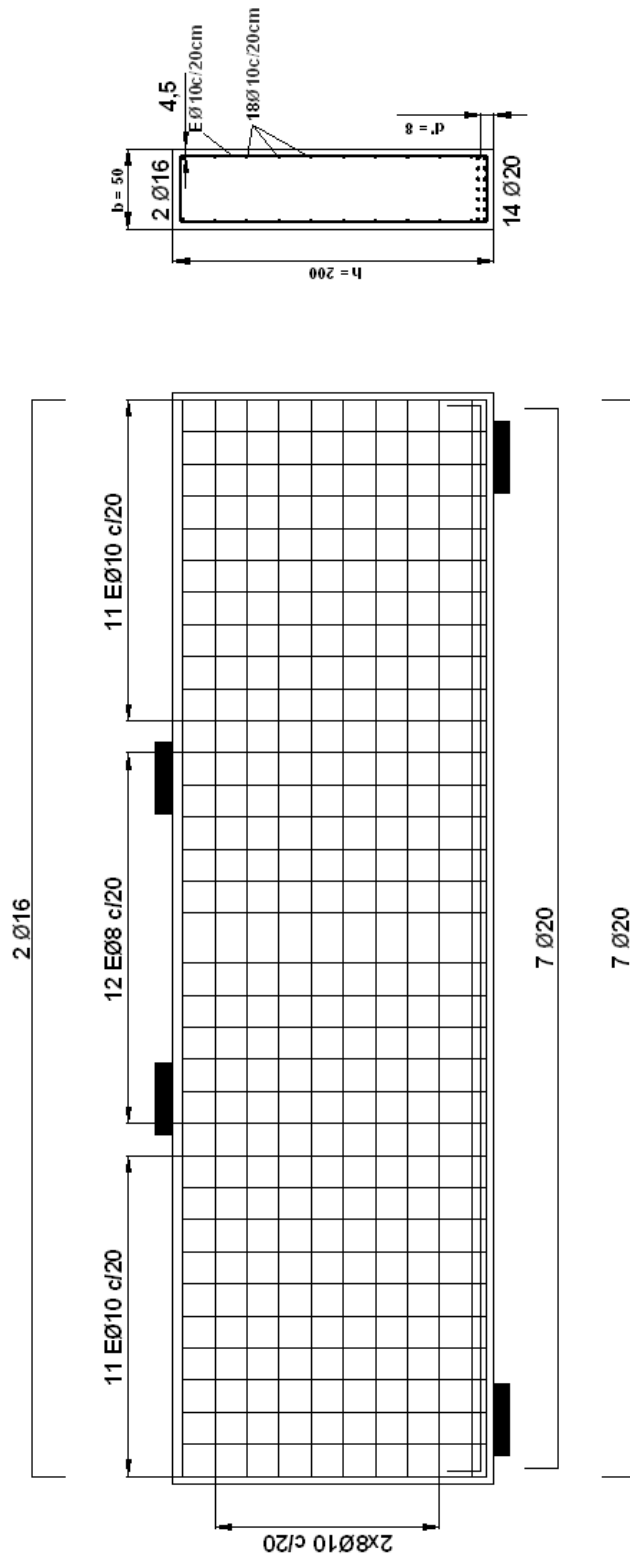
Corte longitudinal e transversal da viga-parede dimensionada - dimensões: cm (acervo pessoal, 2016)
